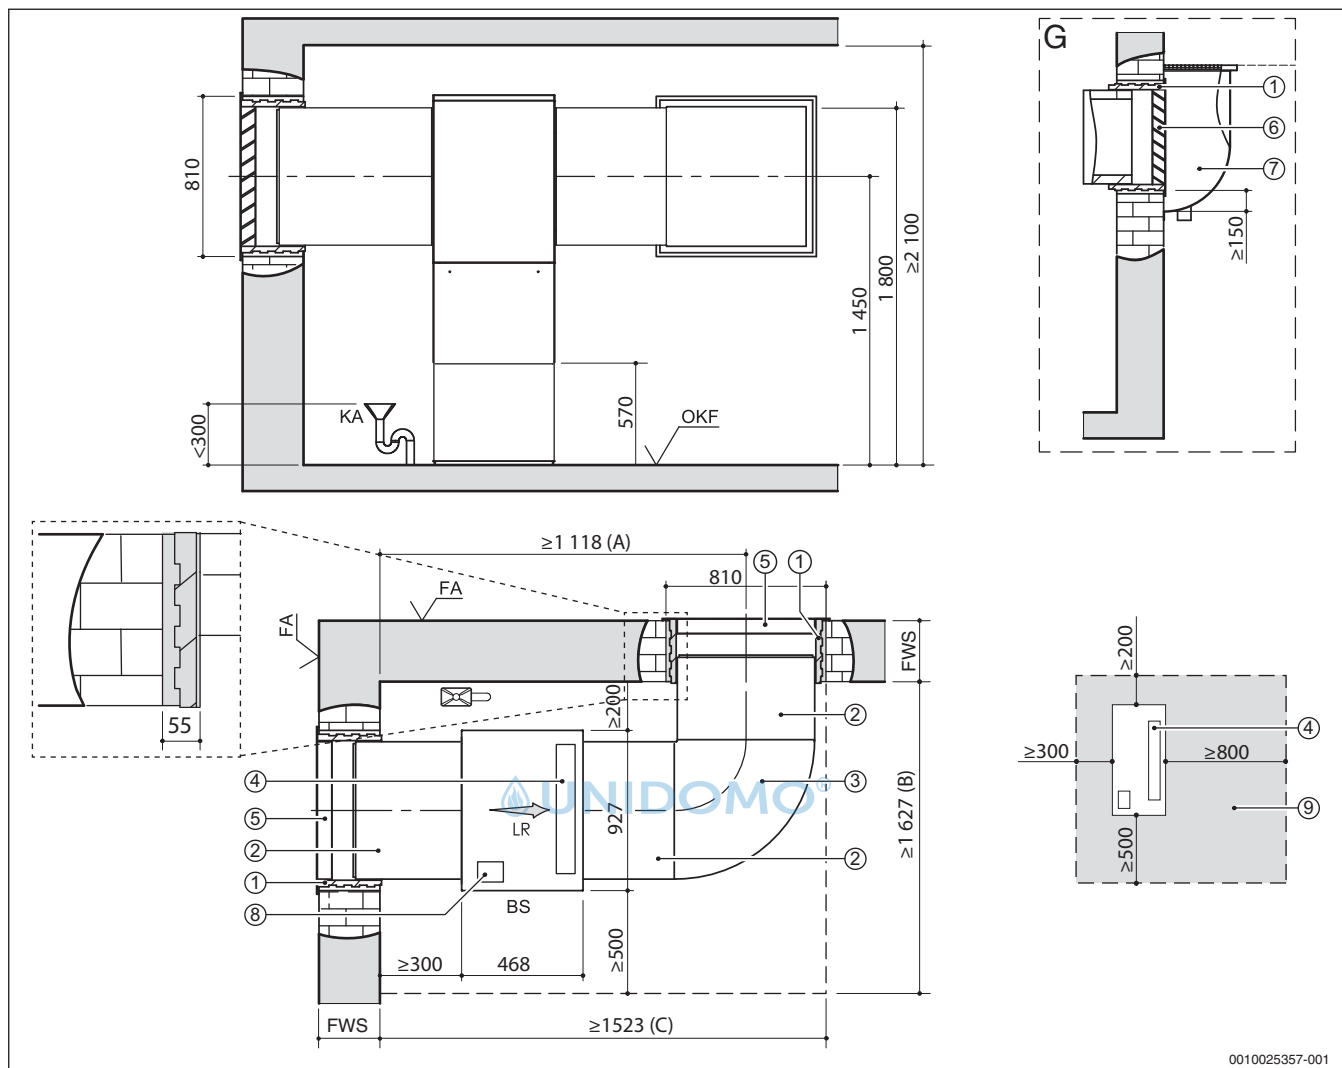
Aufstellplan (beispielhaft) für WLW196i-6/8 IR mit Luftkanalsystem 700 (alle Maße in mm)
